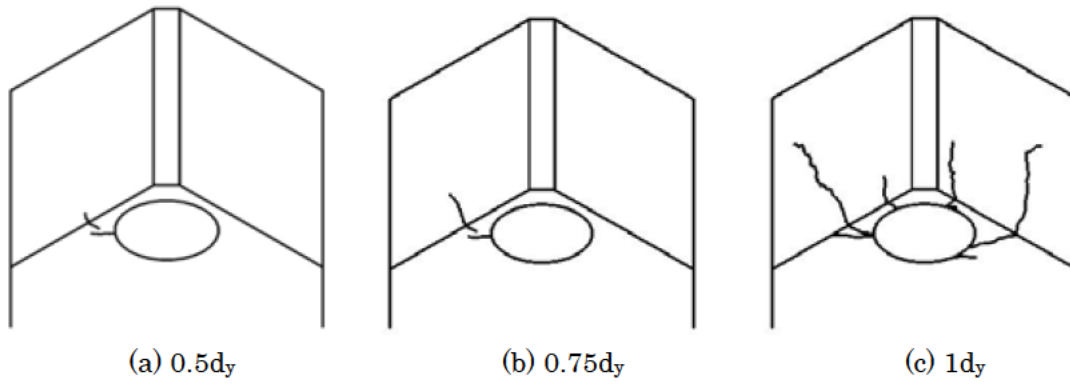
フーチング下面の最終ひび割れ状況図 (Case CPP-C-1, Pile A)
